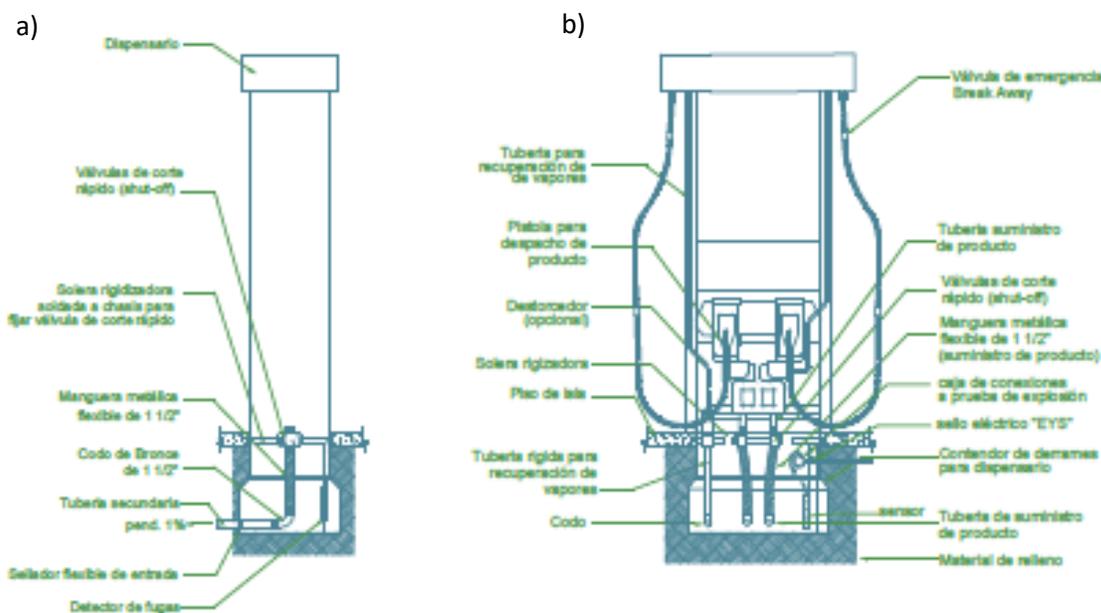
Detalle del dispensario. a) Corte transversal y b) Corte longitudinal.
